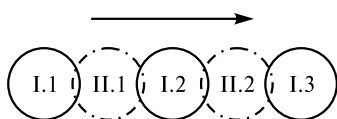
Последовательность устройства стены в грунте методом секущихся свай: I, II — номера потоков; 1, 2, 3 — последовательность устройства буронабивных свай
